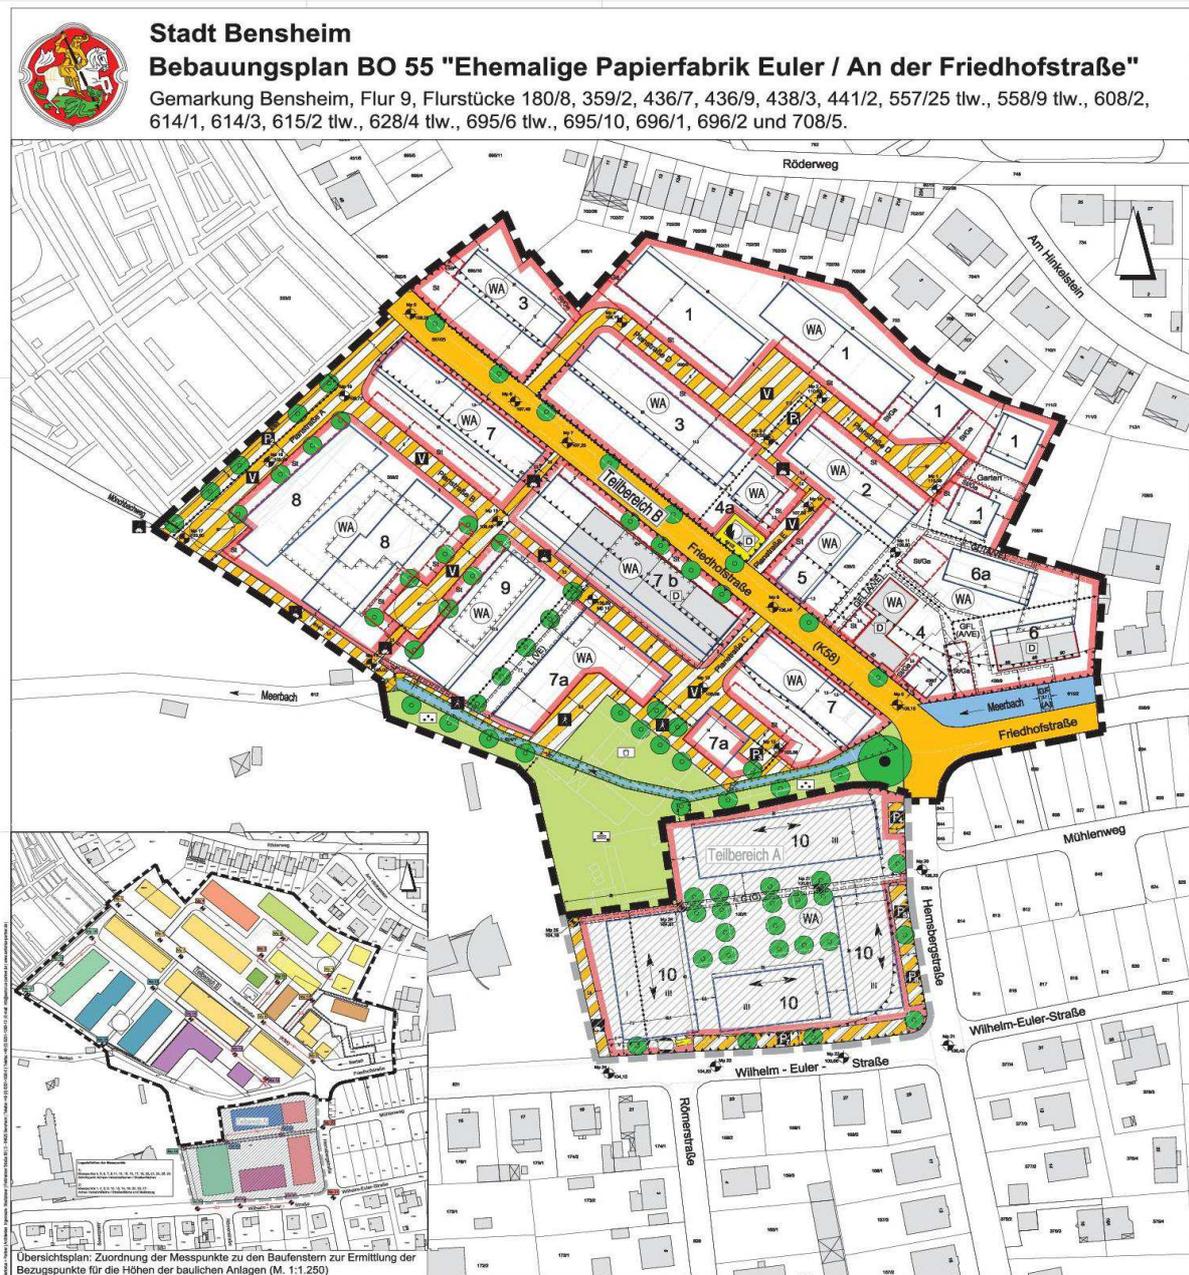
Ursprungsbebauungsplan BO 55 B (unmaßstäblich)
